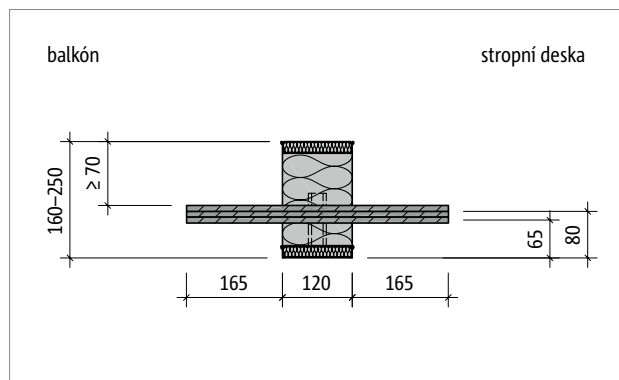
Schöck Isokorb® XT typ HP-NN1: Půdorys prvku
